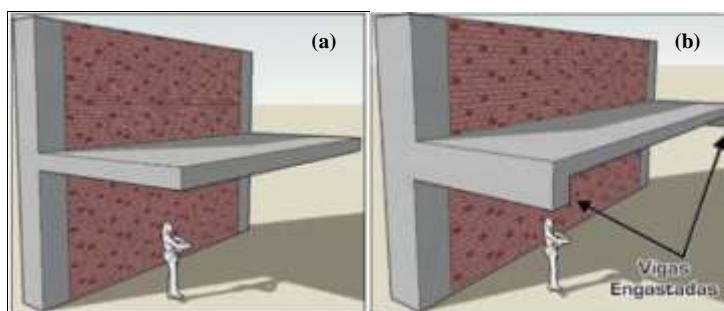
Marquises: (a) com laje simples em balanço; (b) com lajes e vigas [3].
